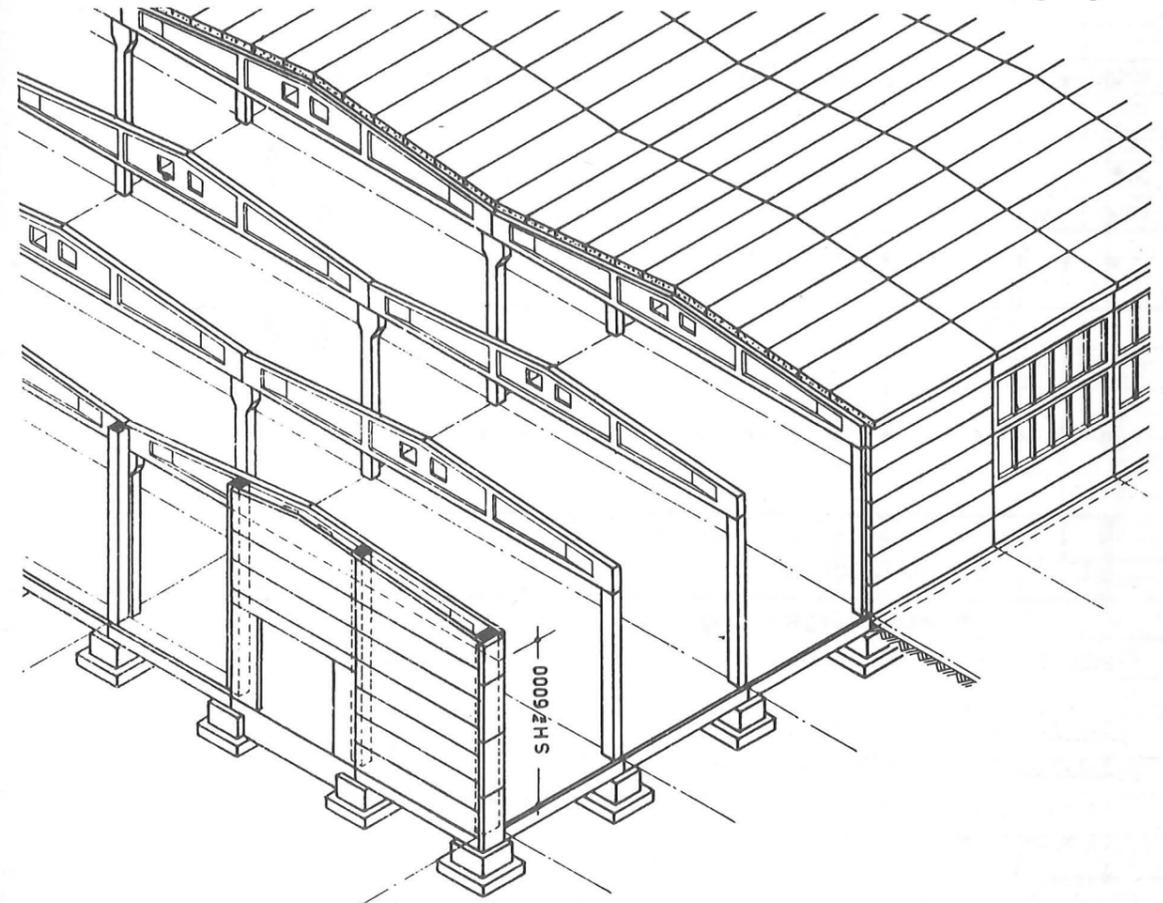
Isometrische Darstellung einer mehrschiffigen Halle mit Satteldach - Vollwandbin-
